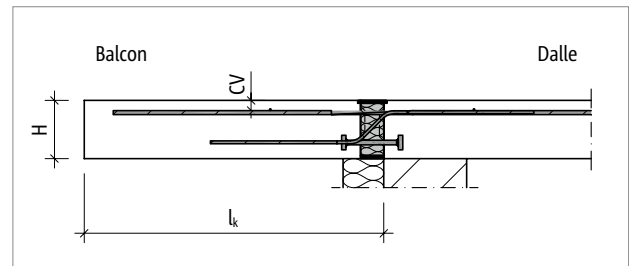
Schöck Isokorb® T Type K-M12 : Système statique
